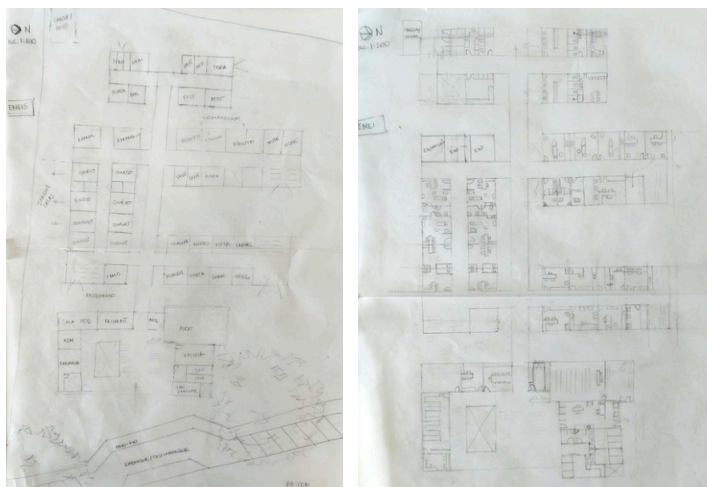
Croqui: estudo de planta e layout. Elaborado pela autora.
